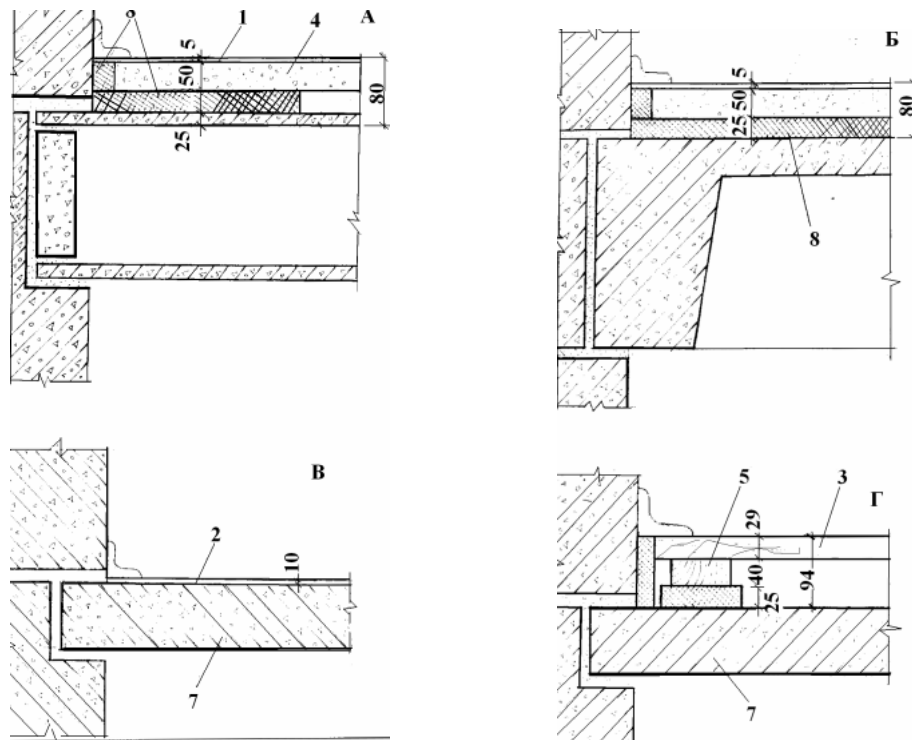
Конструкція підлоги на залізобетонній плиті: 1, 2 – лінолеум; 3 – дерев'яна дошка; 4 – стяжка; 5 – дерев'яний стовпчик; 6 – утеплювач; 7 – залізобетонна плита; 8 – тепло-або звукоізолюючий шар
